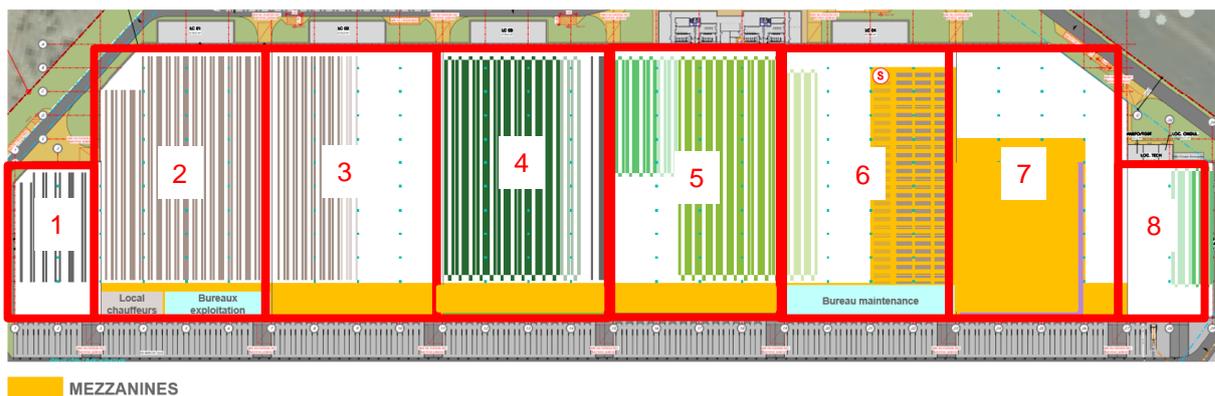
Plan de l'étage R+1 de la mezzanine
